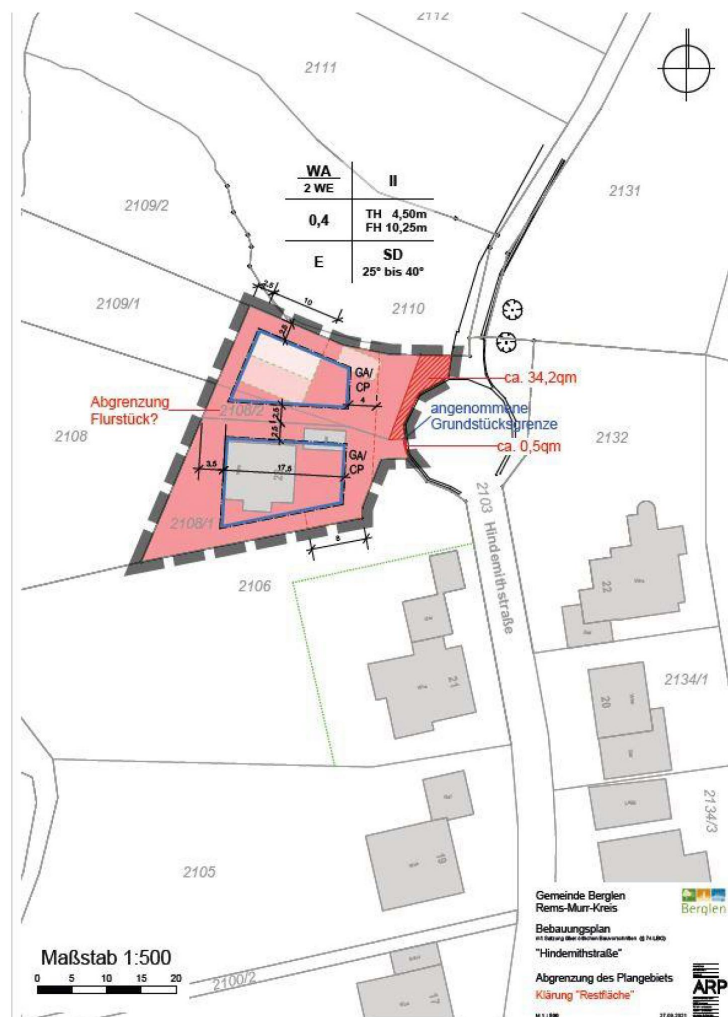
Abgrenzung des Plangebiets (ARP Stuttgart) (alte Bezeichnung „Hindemithstraße“)
